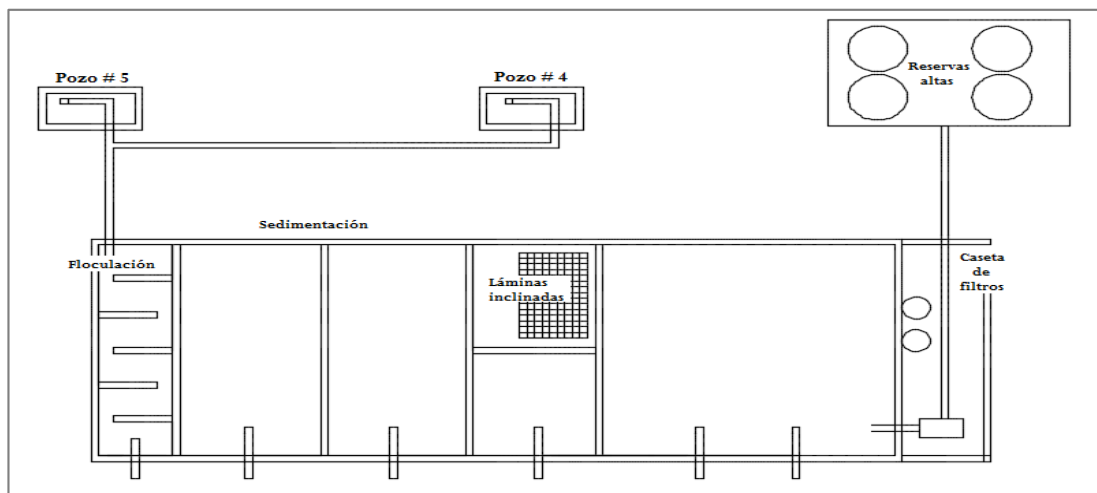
24 Vista en planta – Planta potabilizadora del sector La Curia
